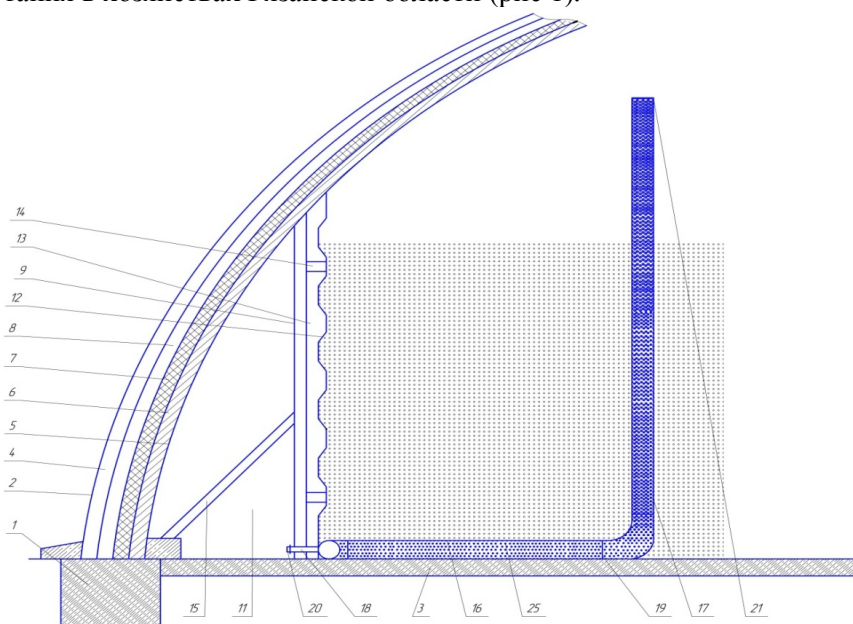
Конструкция картофелехранилища с воздухопроводом в виде цилиндрических труб: 1 – фундамент, 2 – бескаркасный утепленный свод, 3 – бетонный пол, 4 – наружный гнутый лист, 5 – внутренний гнутый лист, 6 – теплоизоляционный вкладыш, 7 – изолирующий вкладыш, 8 – зазор, 9 – опорная стенка, 10 – камера для закладки продукции, 11 – магистральный канал, 12 – вертикальные стойки, 13 – металлические листы, 14 – прямоугольные трубы, 15 – контрфорсы, 16 – горизонтальный воздухопровод, 17 – вертикальный воздухопровод, 18 – окна, 19 – колено, 20 – регулирующая заслонка, 21 – цилиндрическая заглушка, 25 – вентиляционные отверстия.
